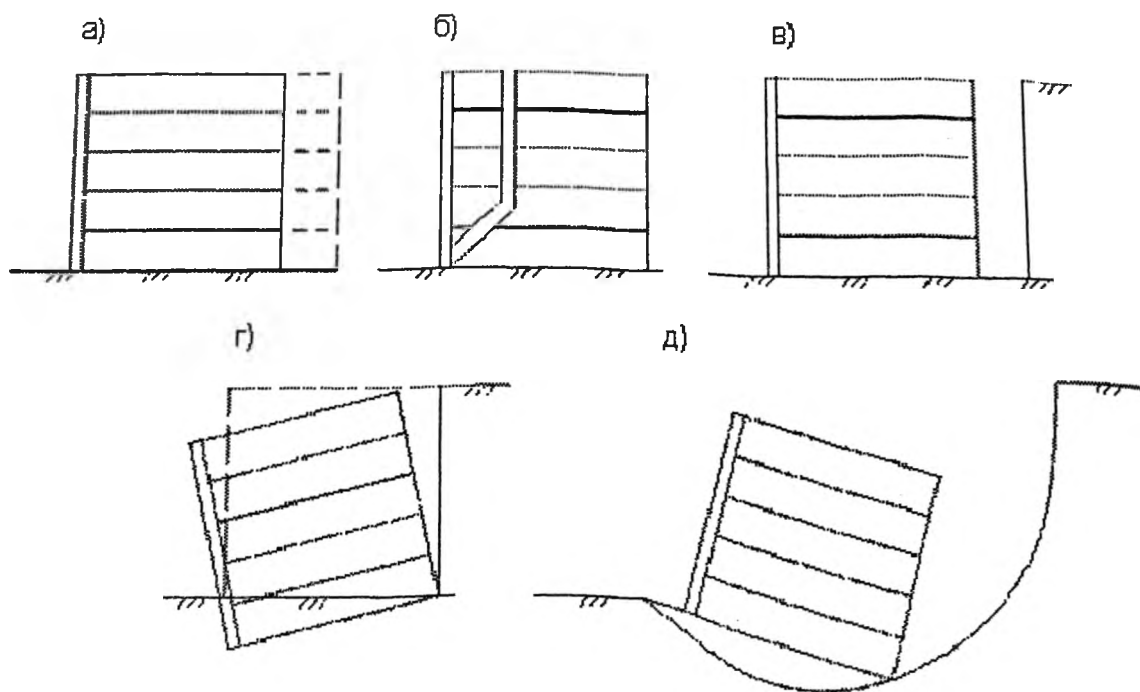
Механизмы разрушения подпорных сооружений из армированного грунта
